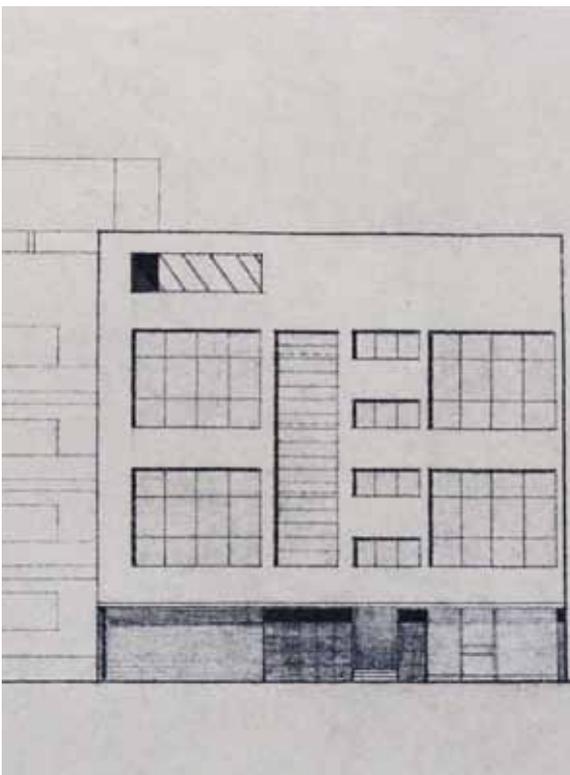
, Fig. 3.48. Propuestas para fachada hacia Parque Melchor Ocampo
